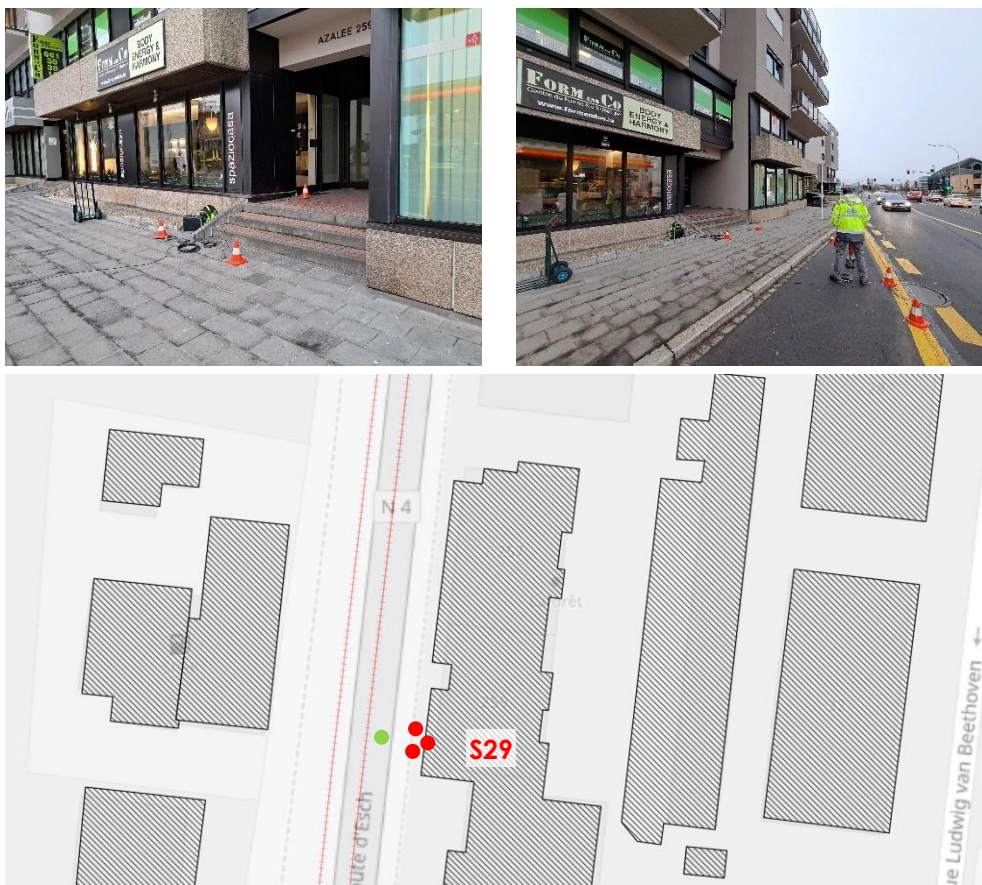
Section de mesures vibratoires S29 – 259, Route d'Esch, 1471 Lux.
